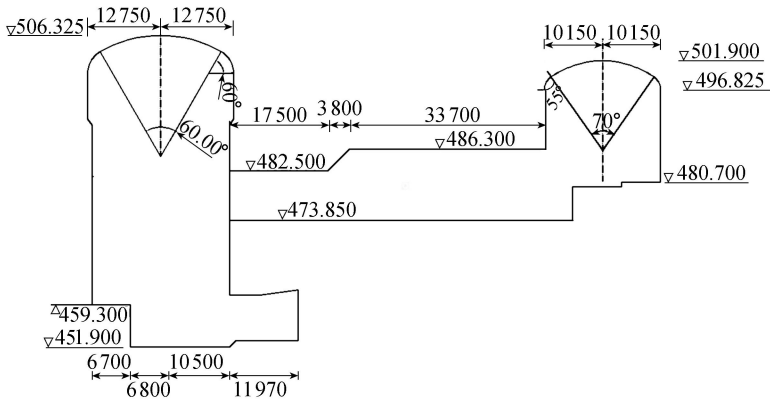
1 号机组剖面图(高程单位:m;长度单位:mm)
